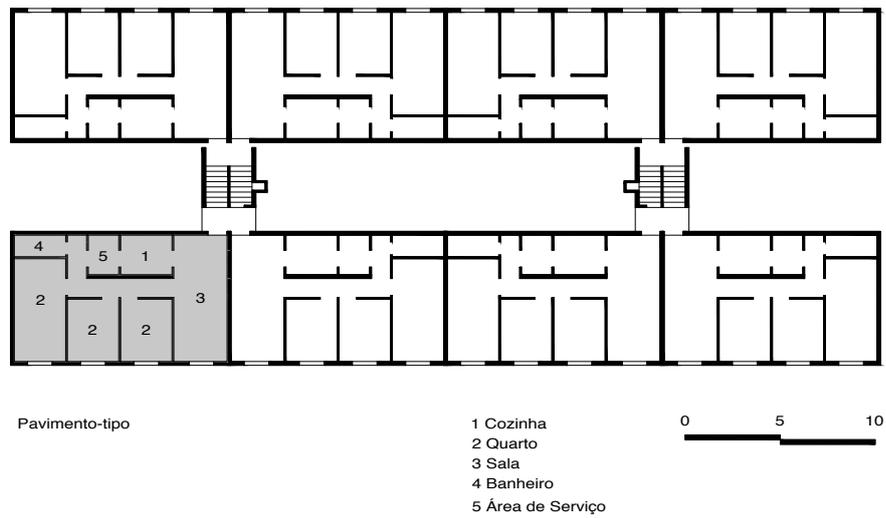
Conjunto Novo Mundo: pavimento tipo.
